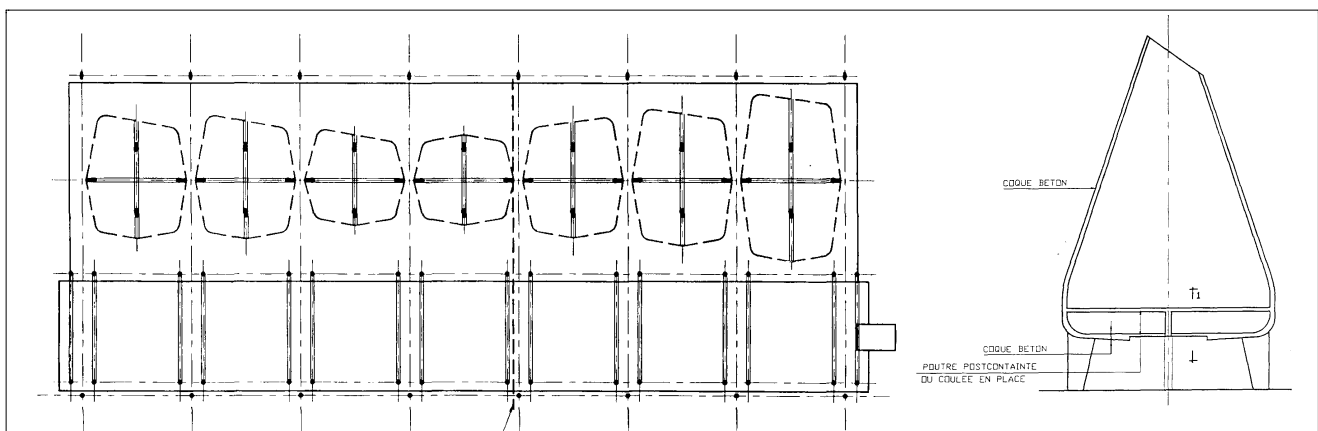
Plan de principe de la structure et coupe longitudinale sur une salle d'audience
